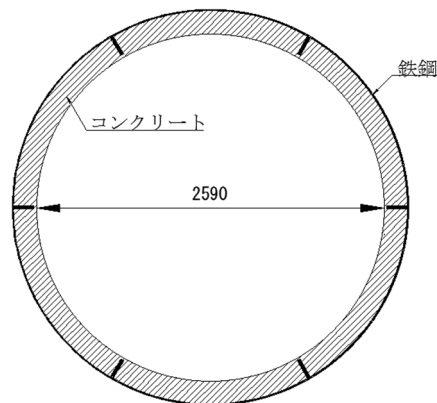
放水トンネル断面図（鉄鋼コンクリート造）
